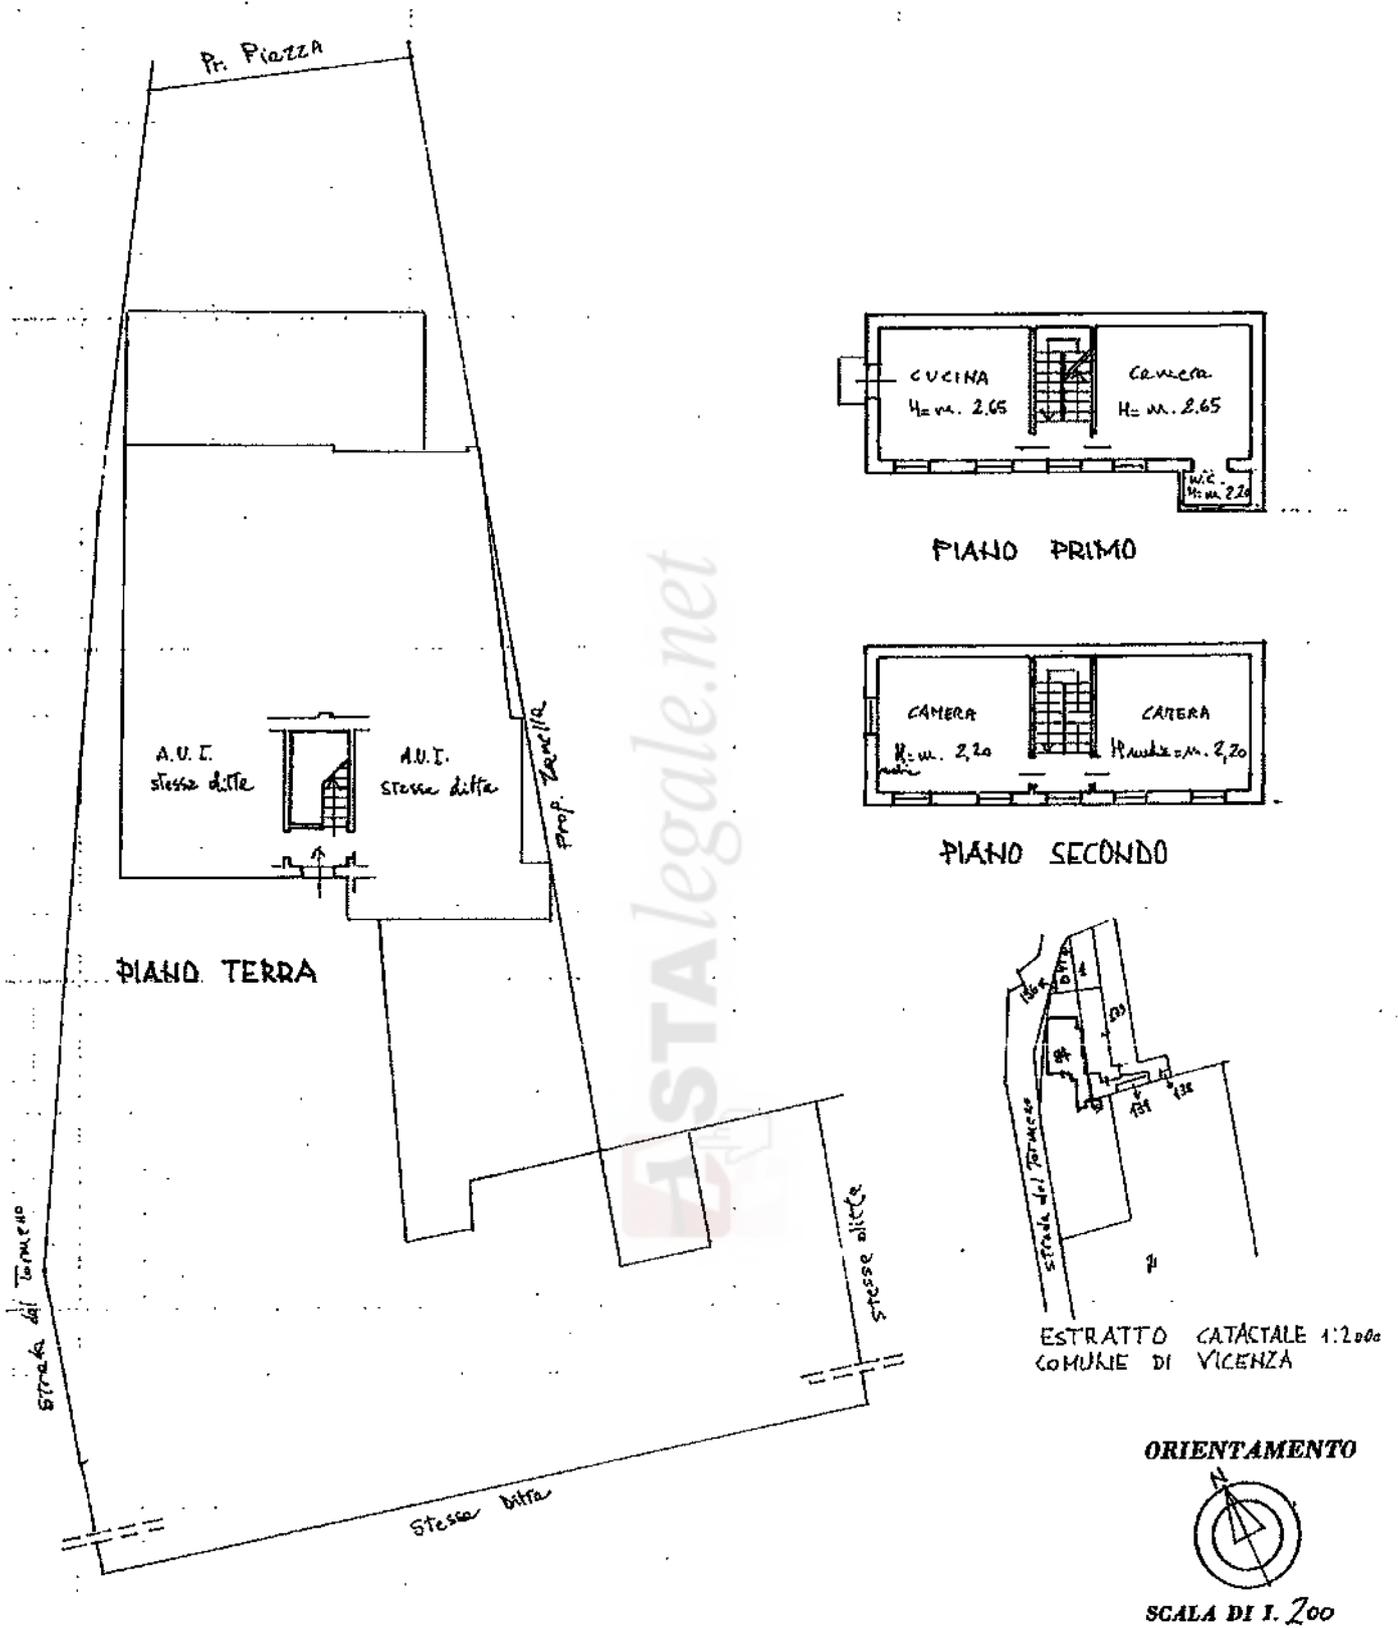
Estratto della planimetria catastale sub. 3 (A3).
